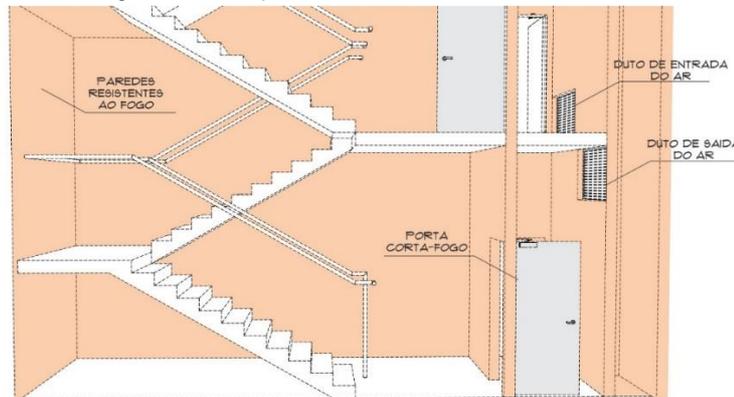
Planta baixa da escada protegida nos pavimentos superiores.
